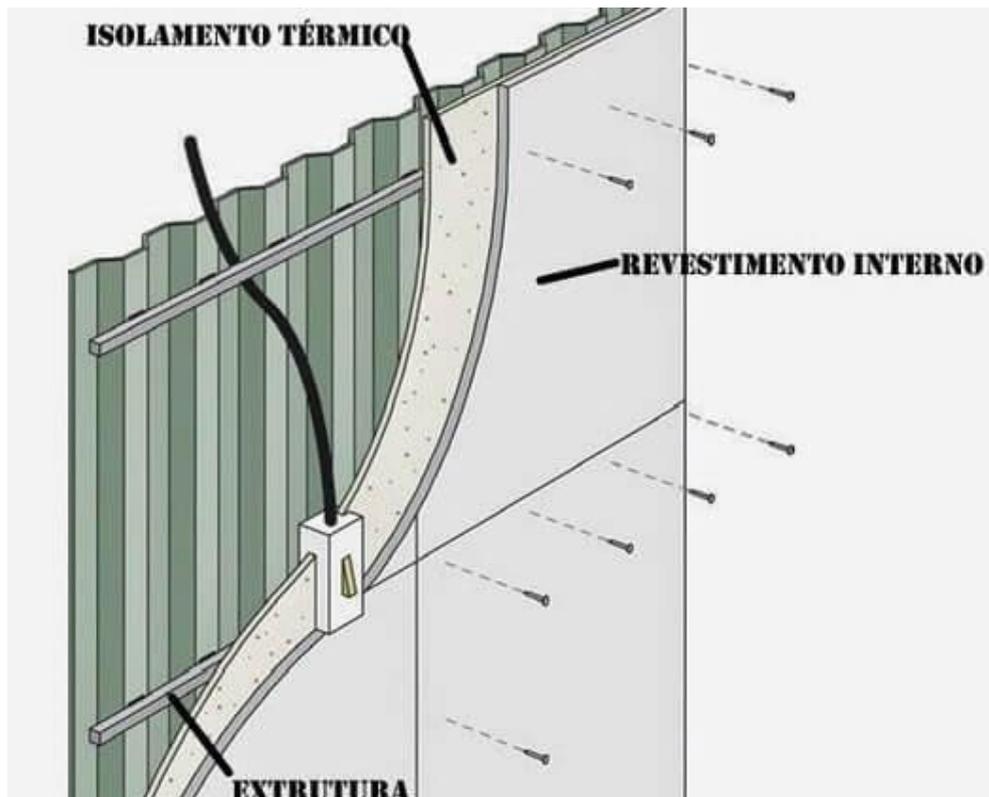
Containers em Construções - Técnicas Construtivas Contemporâneas
